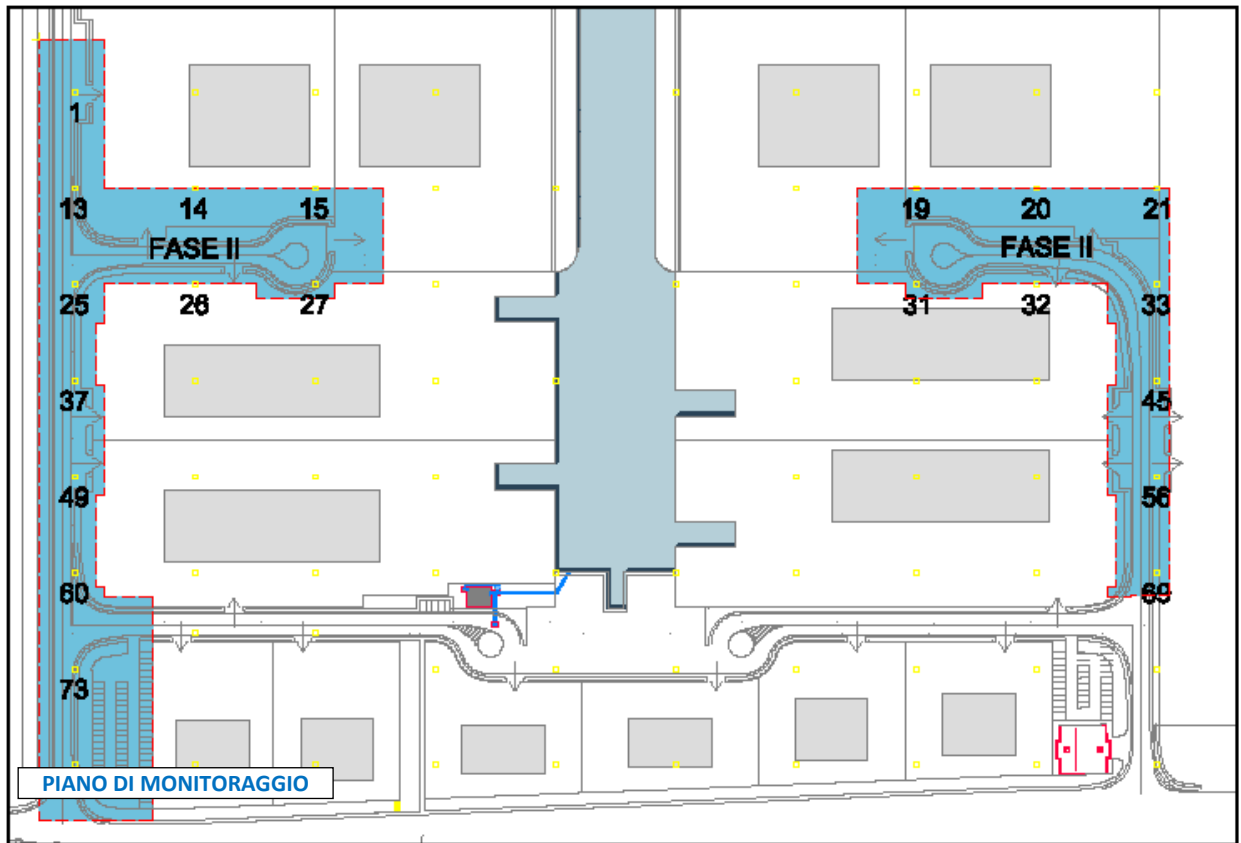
Planimetria delle stazioni di monitoraggio di II FASE.
